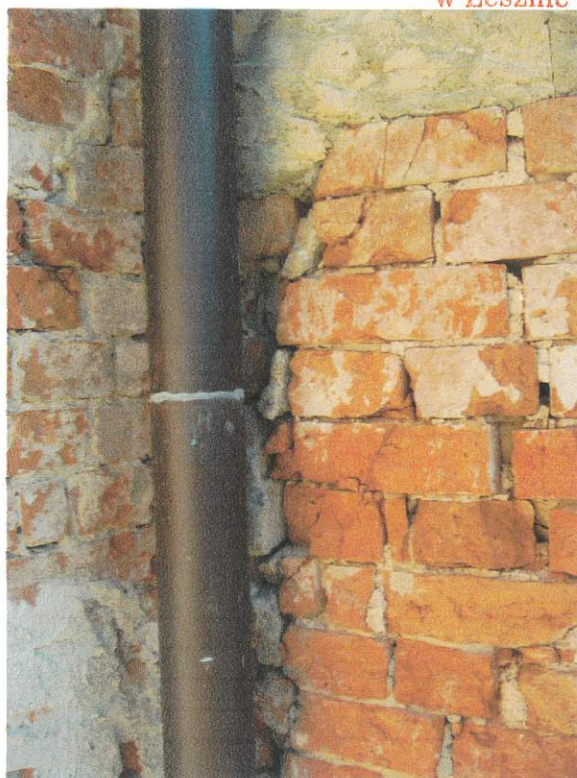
Fragment elewacji południowej po odkuciu tynku - widok wtórnych zamurowań otworów ;
